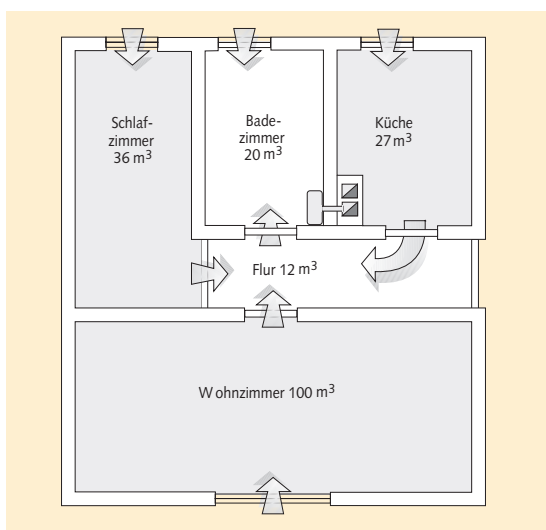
Grundrissbeispiel für die Ermittlung des Verbrennungsluftverbundes
